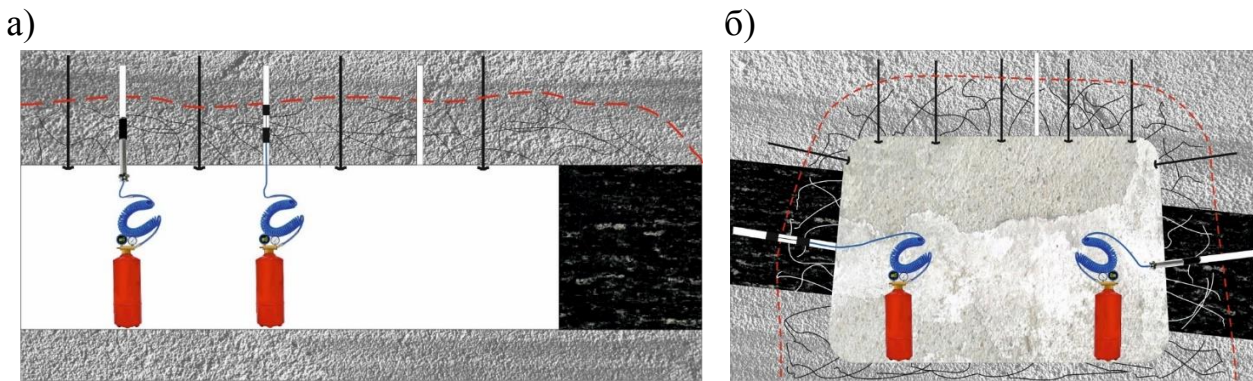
Схема проведения замеров: а) в кровле выработки; б) перед перемычкой
